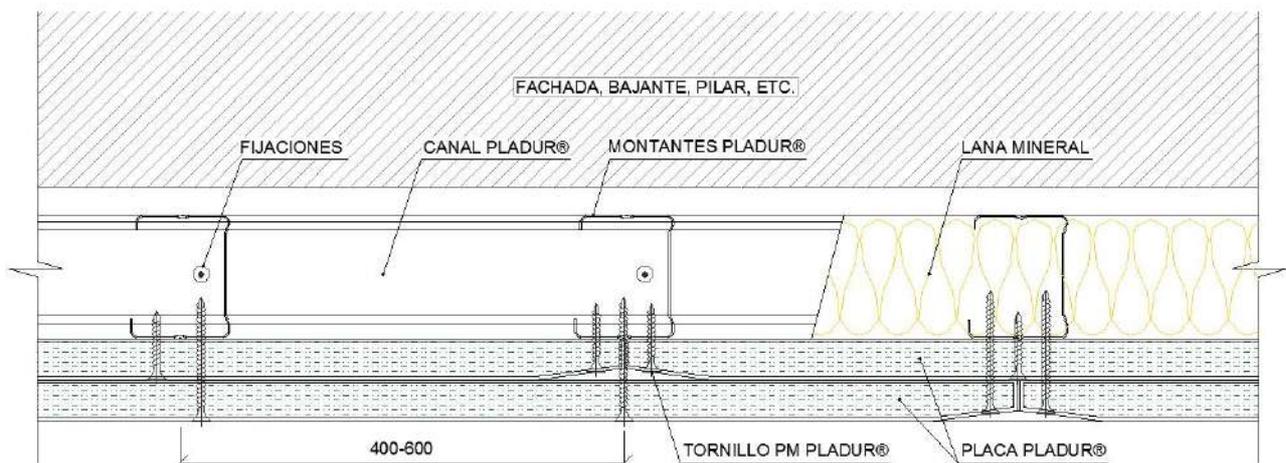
Sección tipo trasdosado de yeso laminado – Fuente: Pladur
